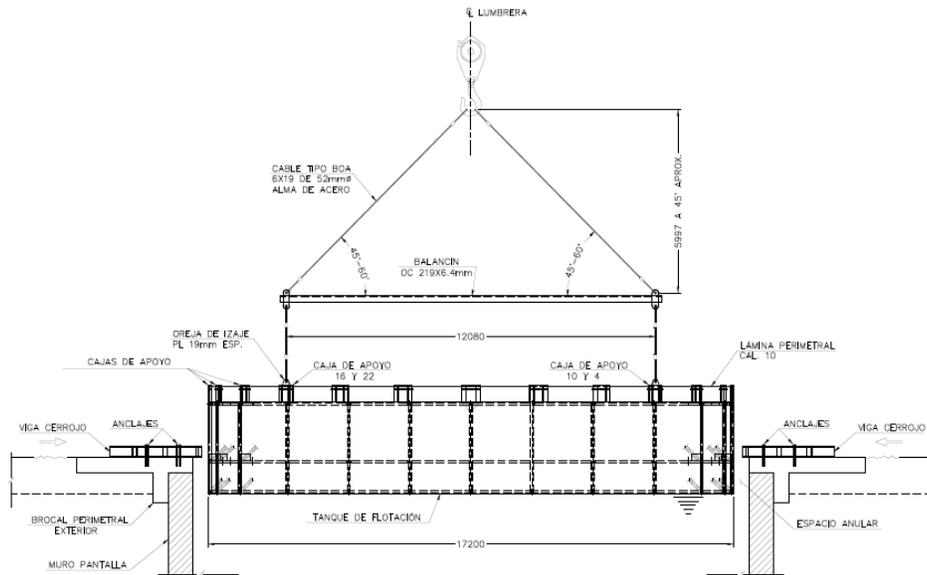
Conjunto de elementos para traslado de tanque.
